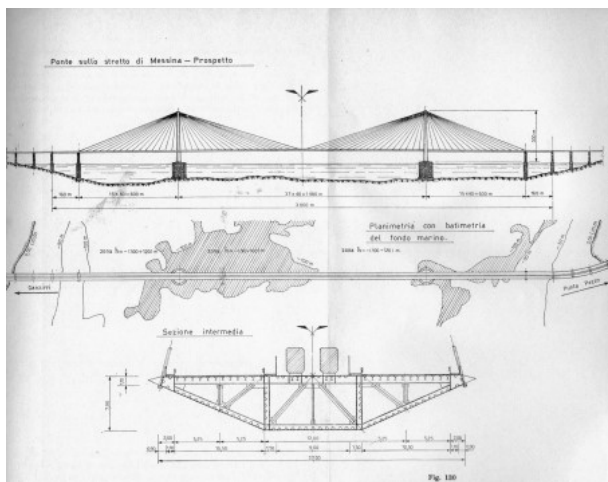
Ponte sullo Stretto di Messina: prospetto e sezione intermedia. Fabrizio De Miranda
